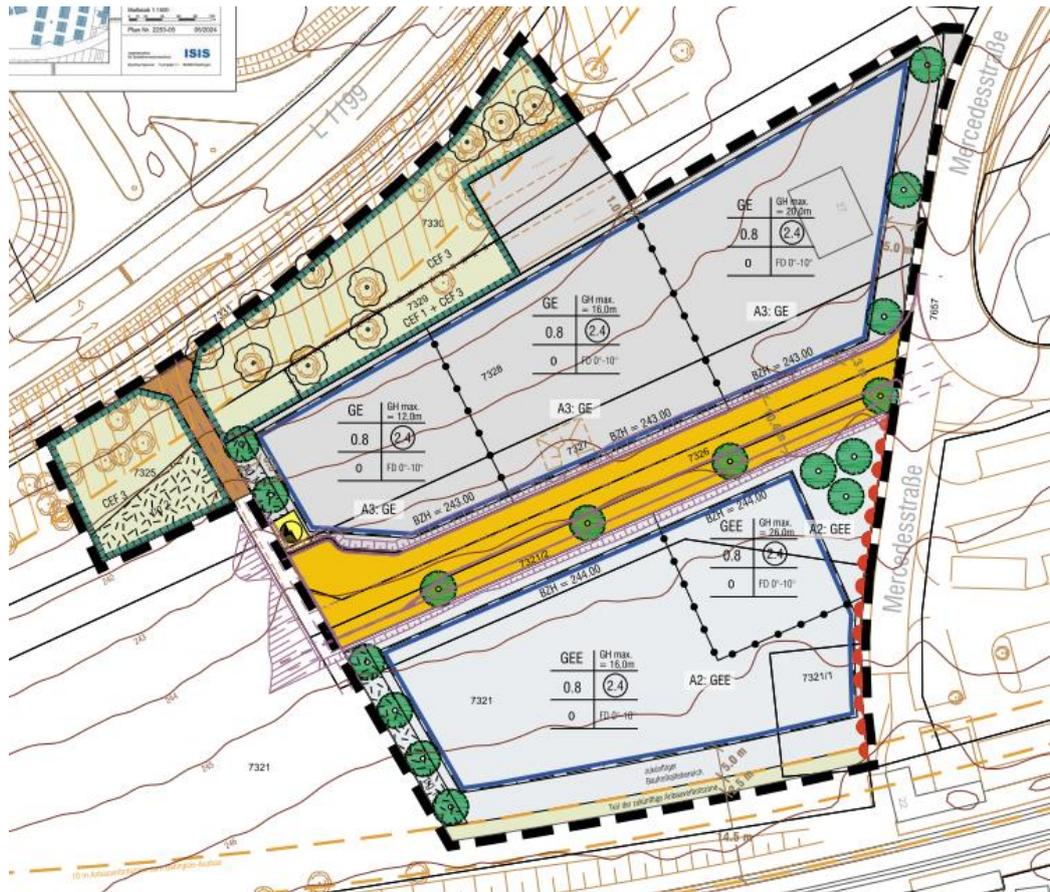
Bebauungsplan, Mai 2024 mit Eintrag der Bauabschnitte
